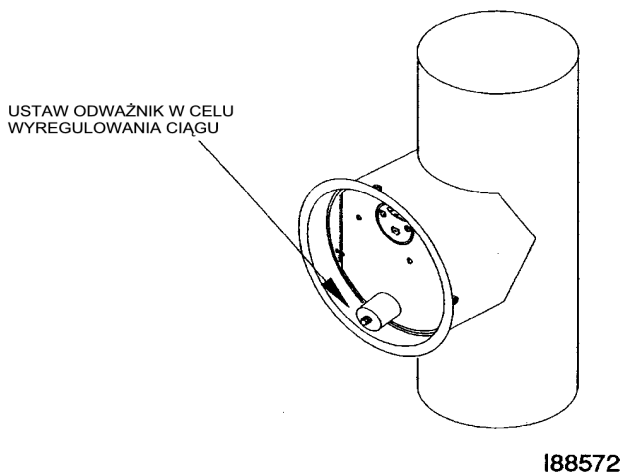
A- sprawdzanie i odczyt poprawnego ciągu
